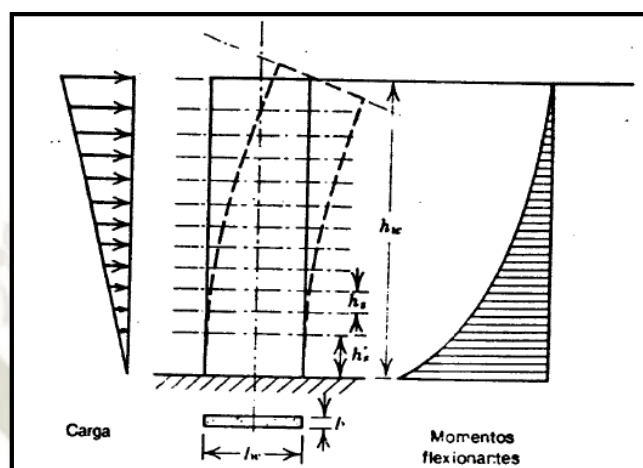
Muro de cortante en voladizo (Park & Paulay, 1988)
